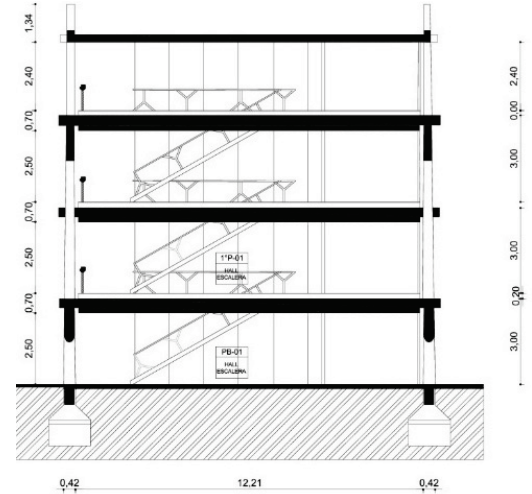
Corte transversal con sistema de escaleras galería y salas.
